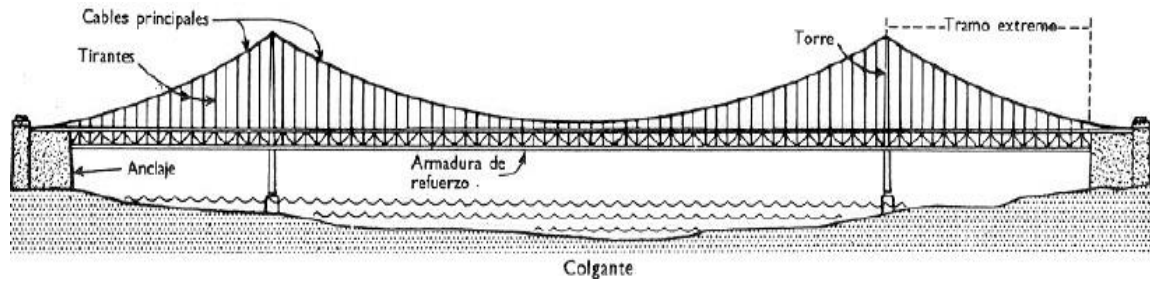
Vista del puente con los cables principales, Tirantes, Torre, Armadura de Refuerzo, Anclaje.
